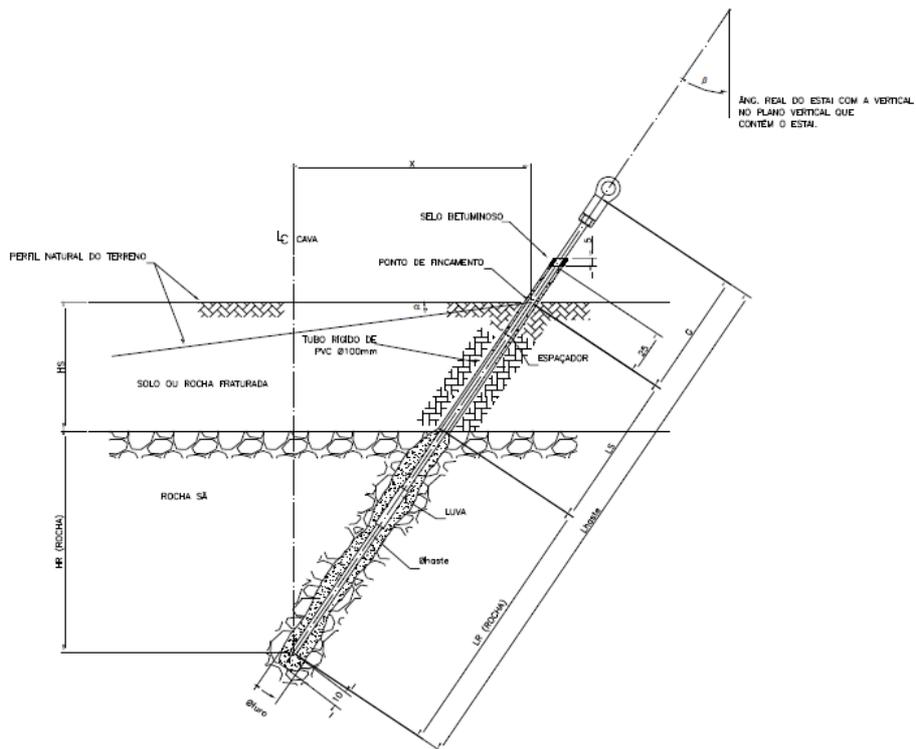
Layout* da fundação tipo tirante injetável em rocha (“Rock Drill”).
